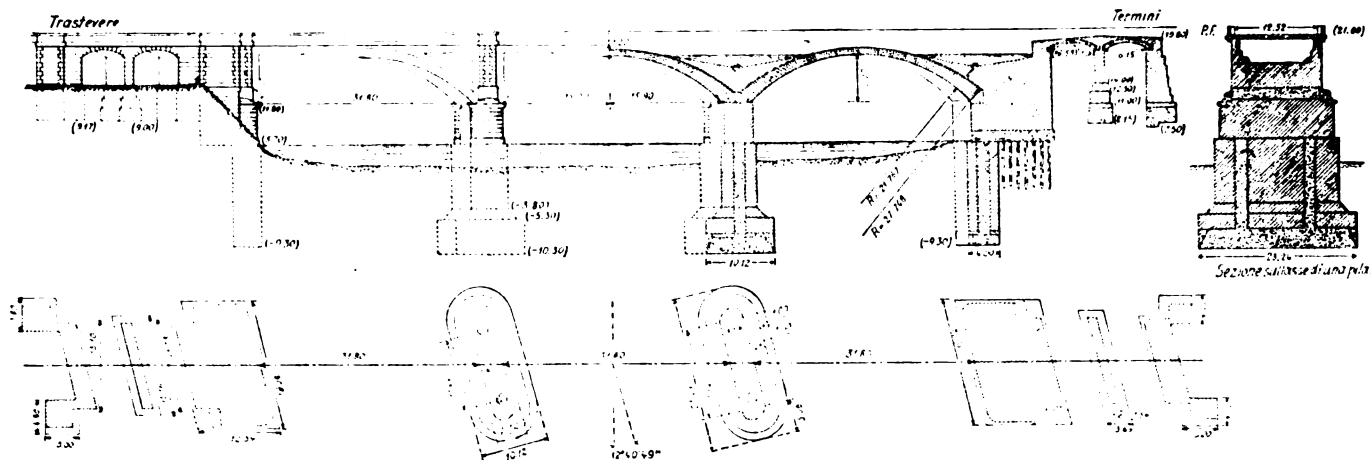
Ponte sul Tevere. - Elevazione, sezioni e pianta.
